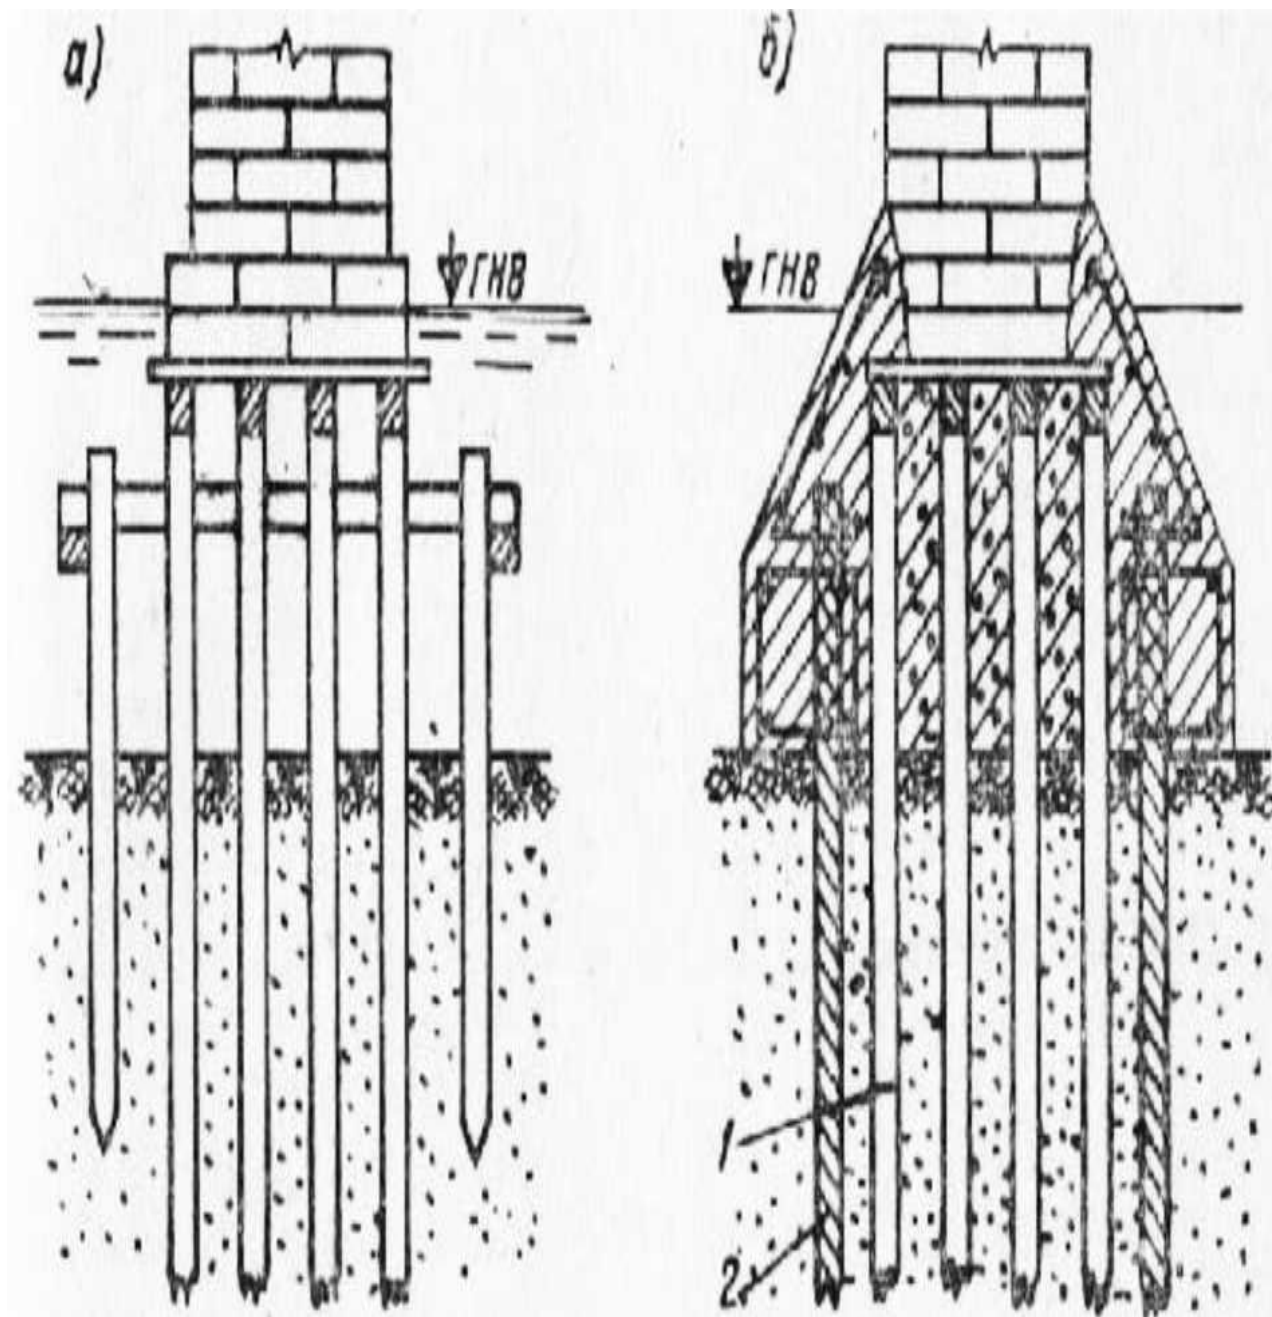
Конструкція опори моста через р. Нарву (а) та схема посилення цієї опори (б) бетонною сорочкою та залізобетонними палями: 1 - дерев'яні палі; 2 - залізобетонна паля
